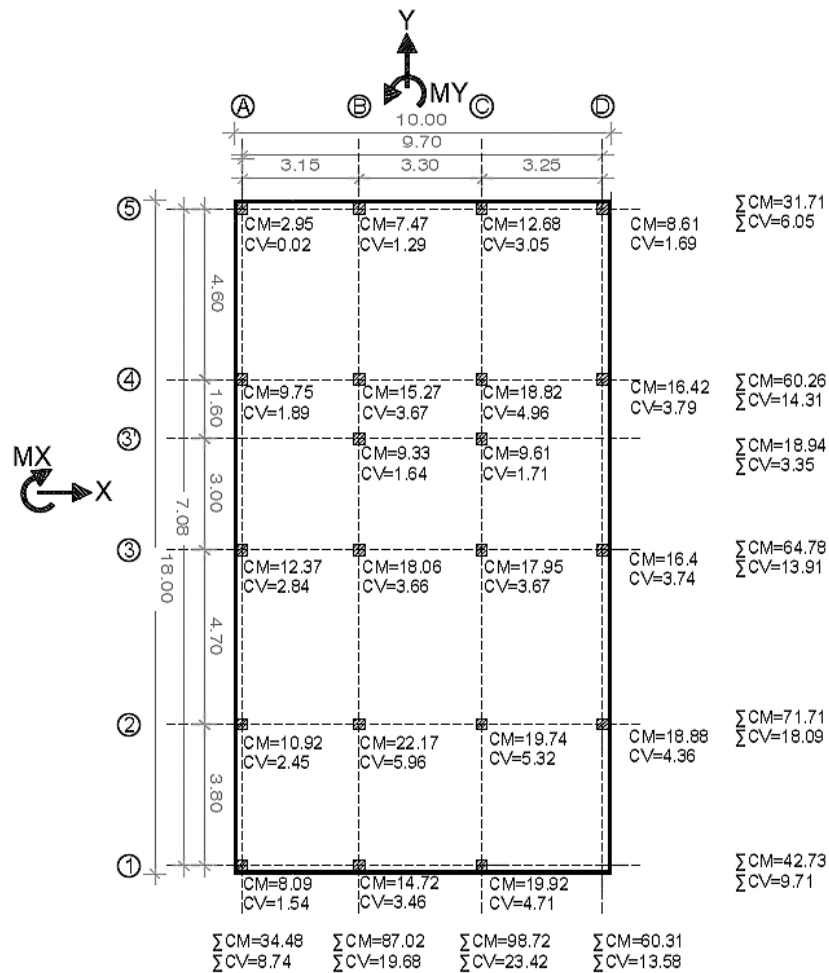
Planta de la edificación en la losa de cimentación y cargas verticales
